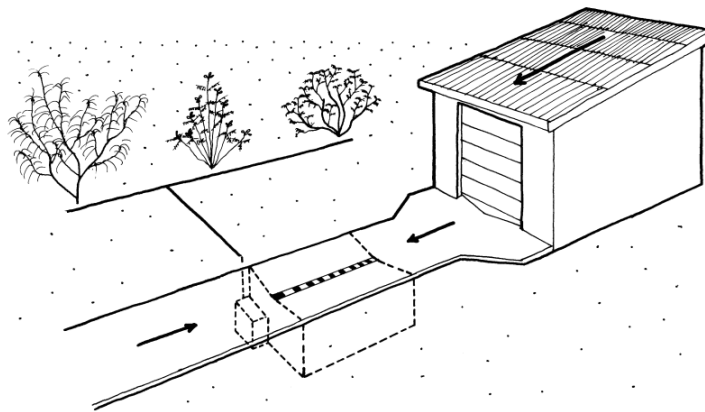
Áreas de captação: telhado e pátio. Armazenamento em reservatório subterrâneo.
